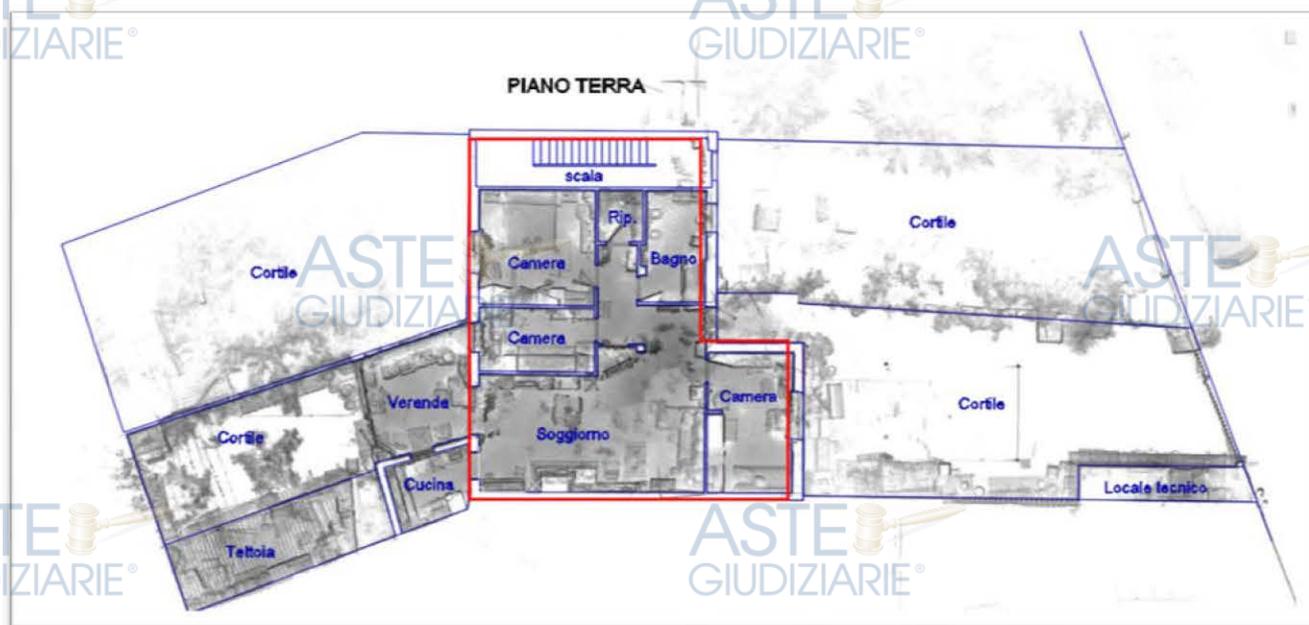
Planimetria stato dei luoghi, in rosso ingombro sedime di progetto.
